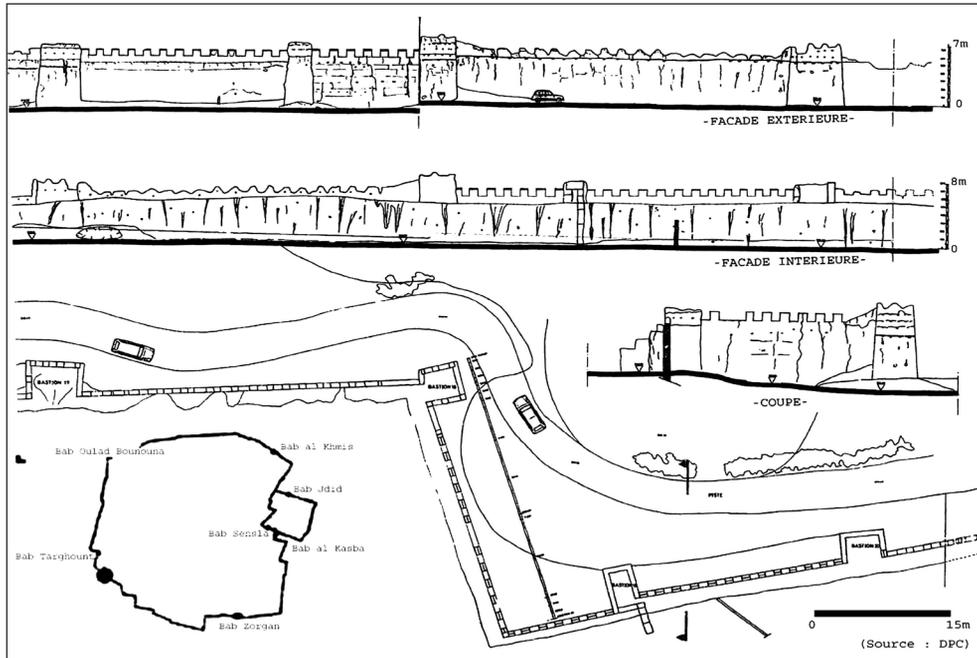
Muraille de Taroudant, côté Sud-Ouest (Plan, façades et coupe), (Source: DPC).
